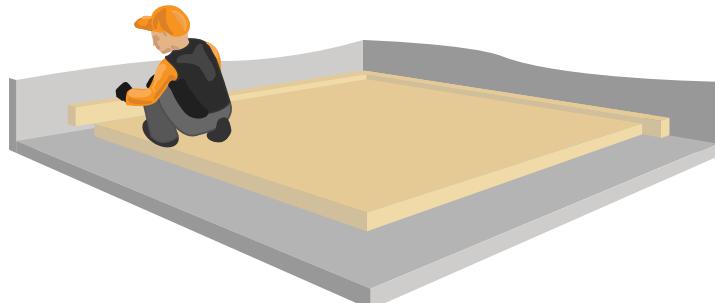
Схема укладки гидроизоляционного слоя
